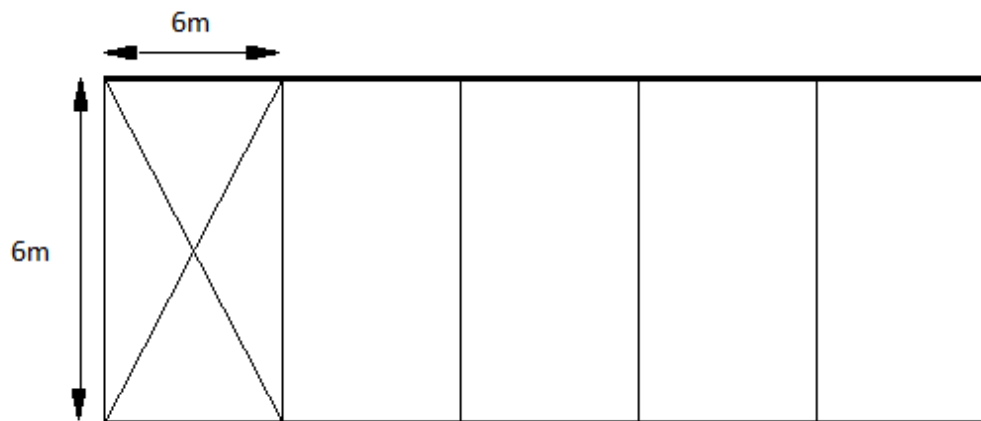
2 : Plan de portiques de la palée de stabilité.
